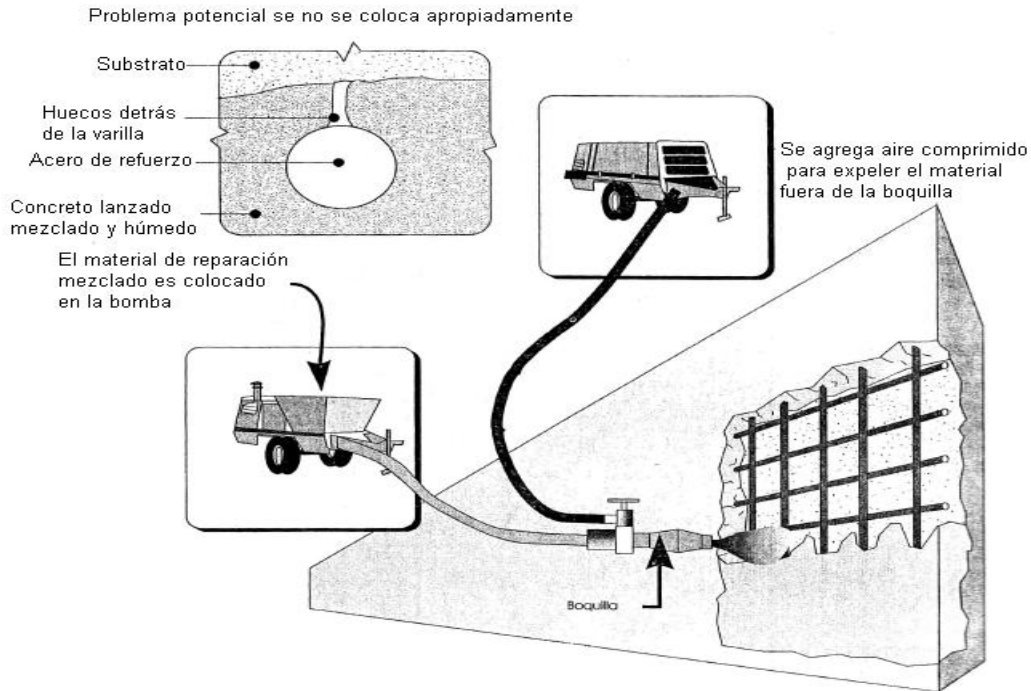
Sistema para lanzamiento de concreto mezclado seco (o mojado)
